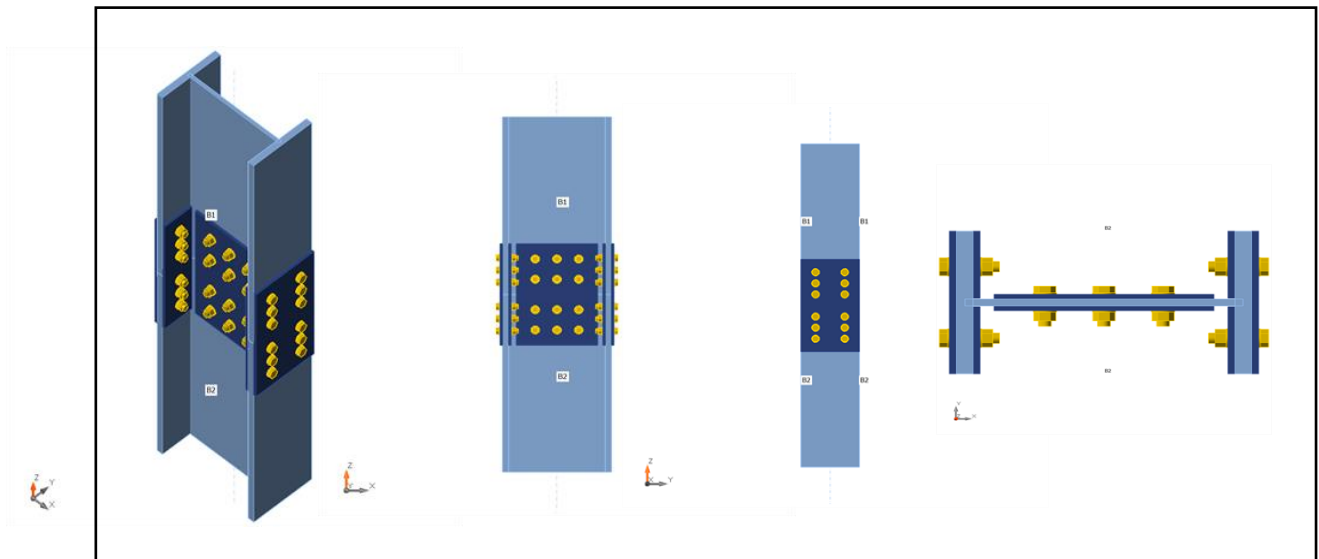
Les Vues d'assemblage poteau – poteau
